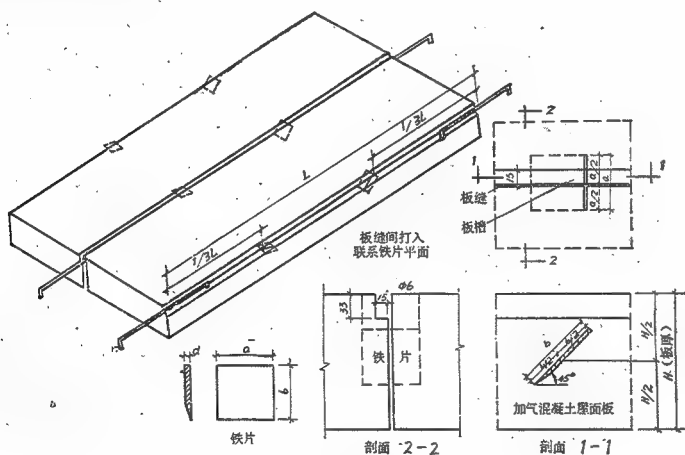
混凝土加气屋面板联系片作法示意图（ ϕ 为钢筋符号）
